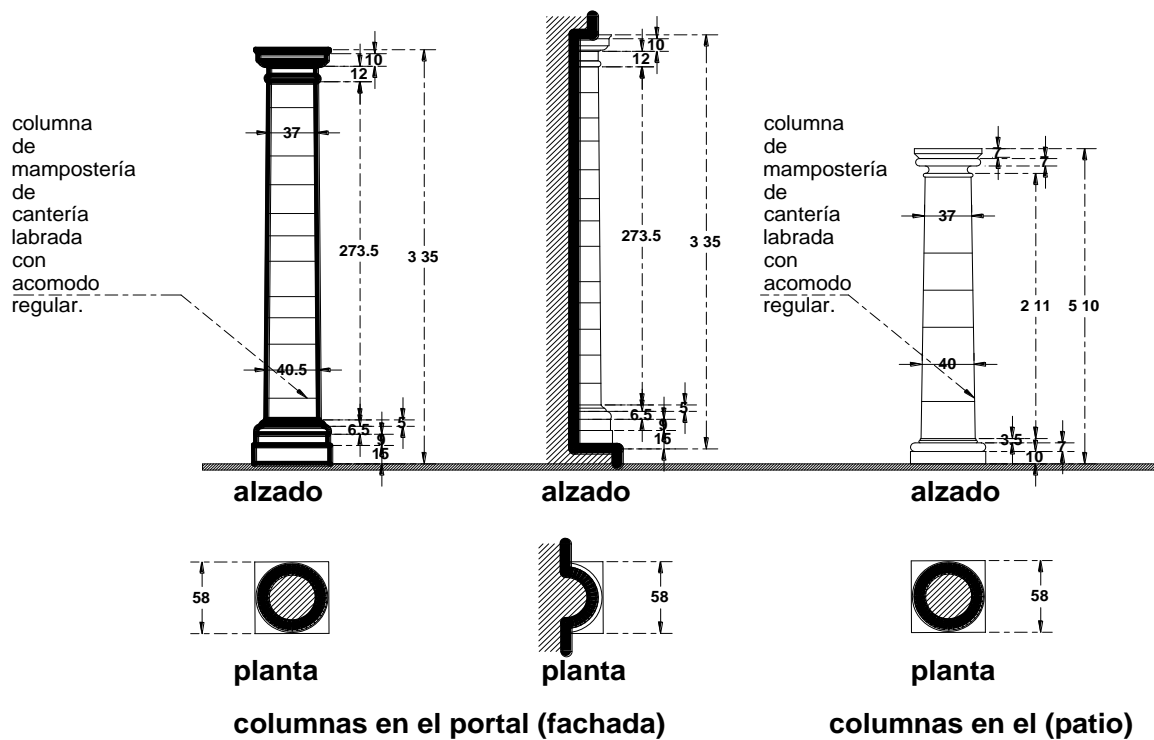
Los dos tipos de apoyos aislados ubicados en la fachada principal y en el patio central.
